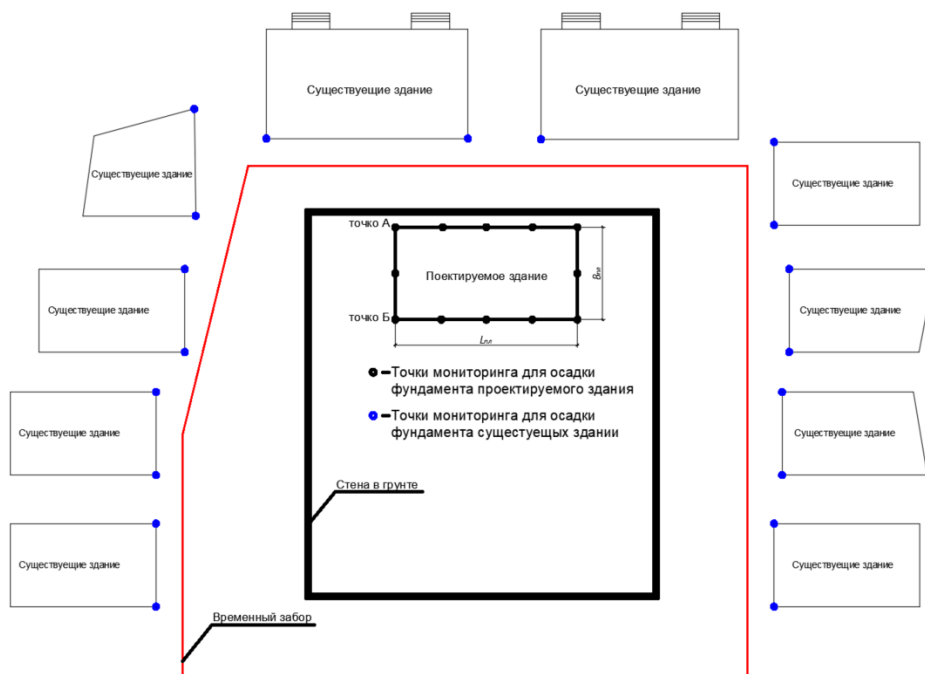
Генеральный план строительной площадки жилого комплекса
